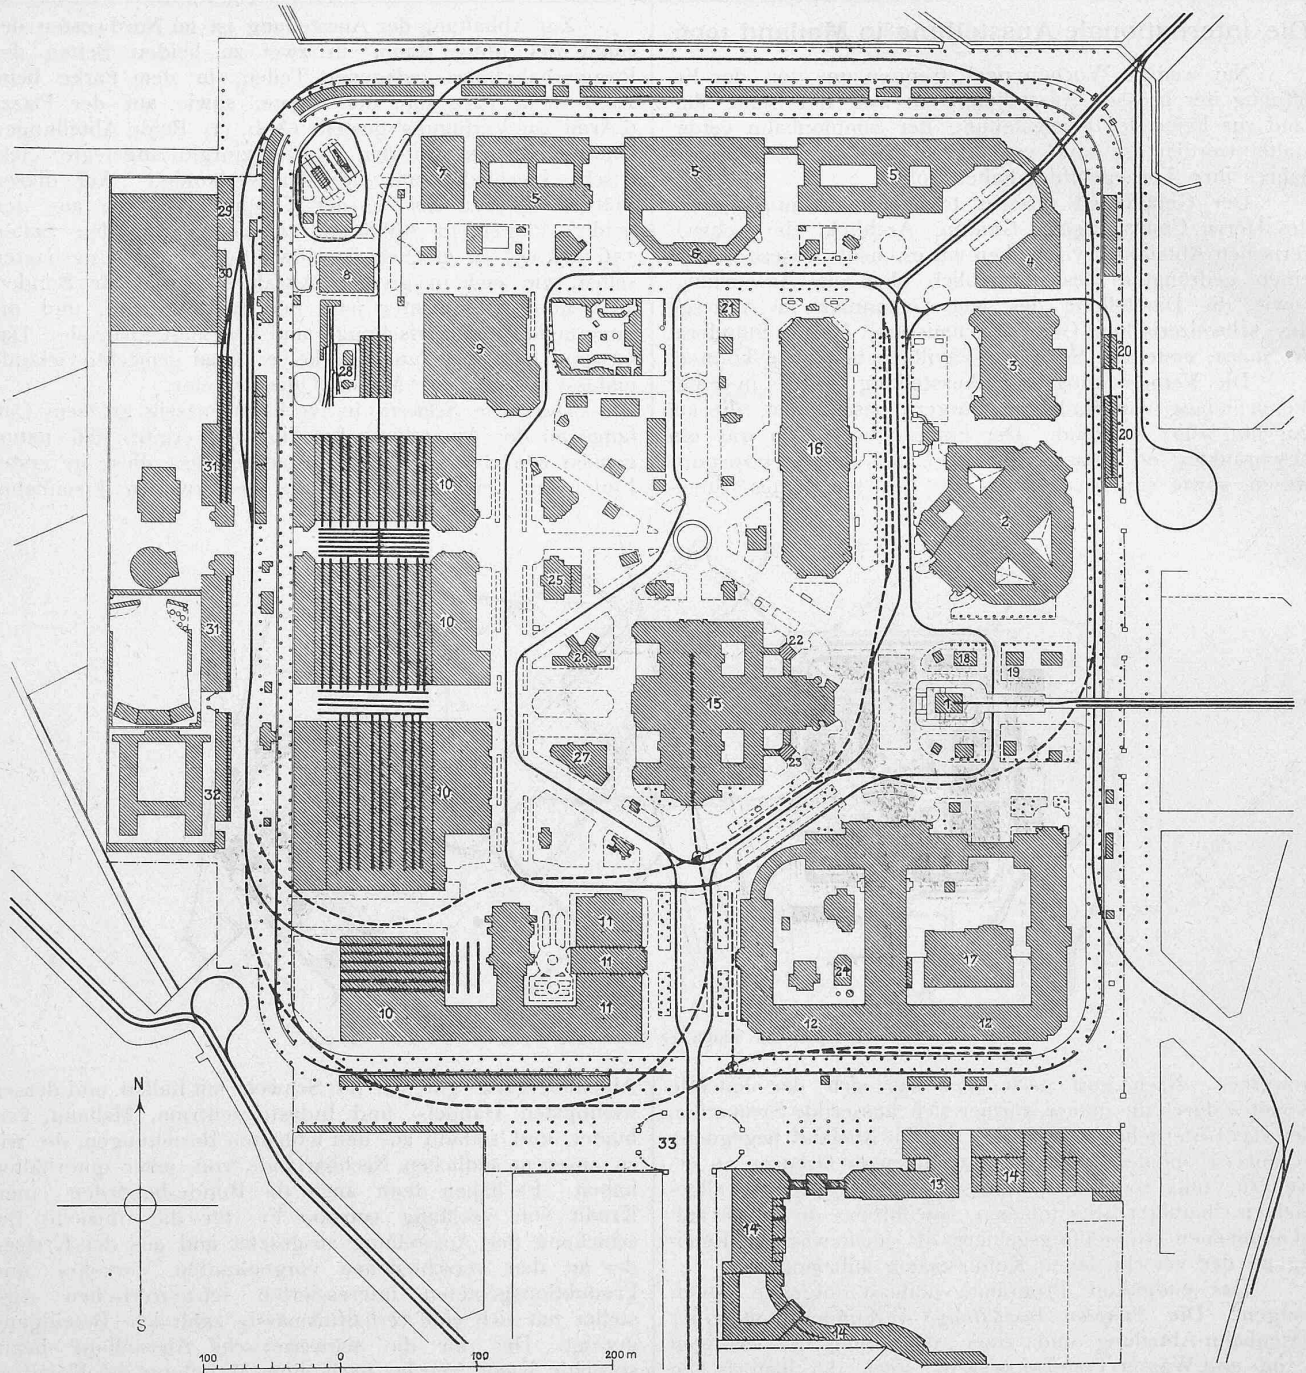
Lageplan der Ausstellung. — Westlicher Teil auf der Piazza d'Armi. — Masstab 1 : 5000.
